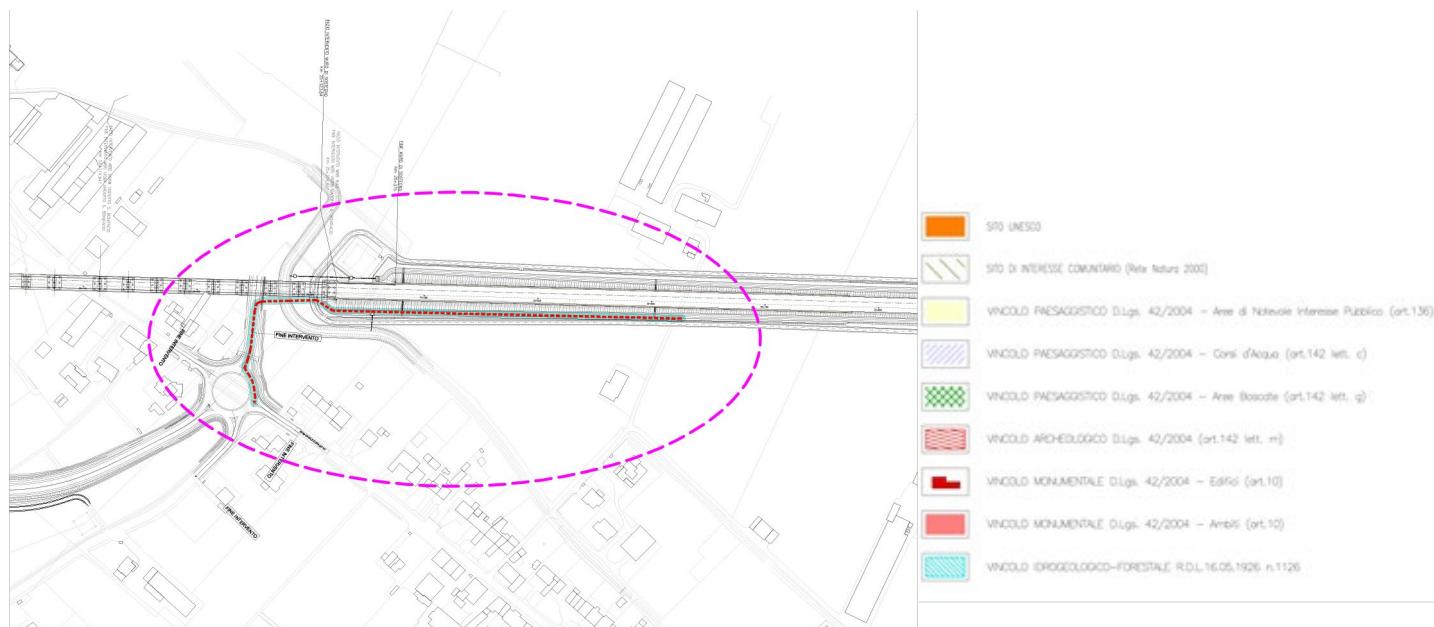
Stralcio Carta dei vincoli Tav. 1/8, con individuazione delle aree interessate dalle varianti.
